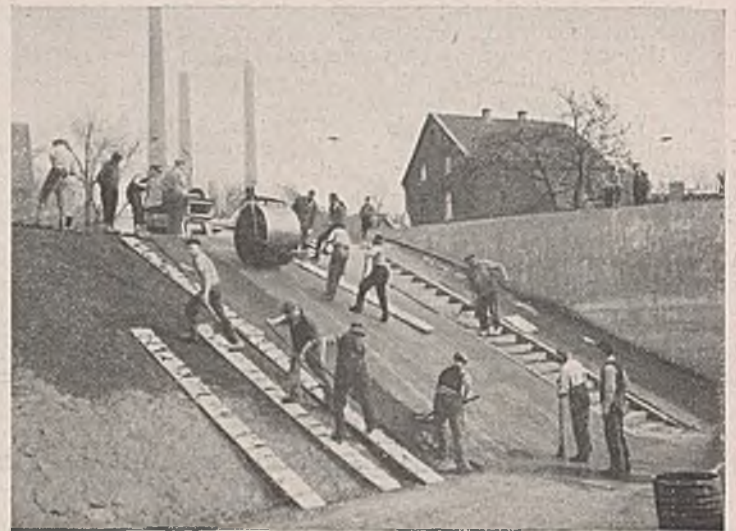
Dichtung der Böschungen, Bügeln der Anschlußstreifen.
